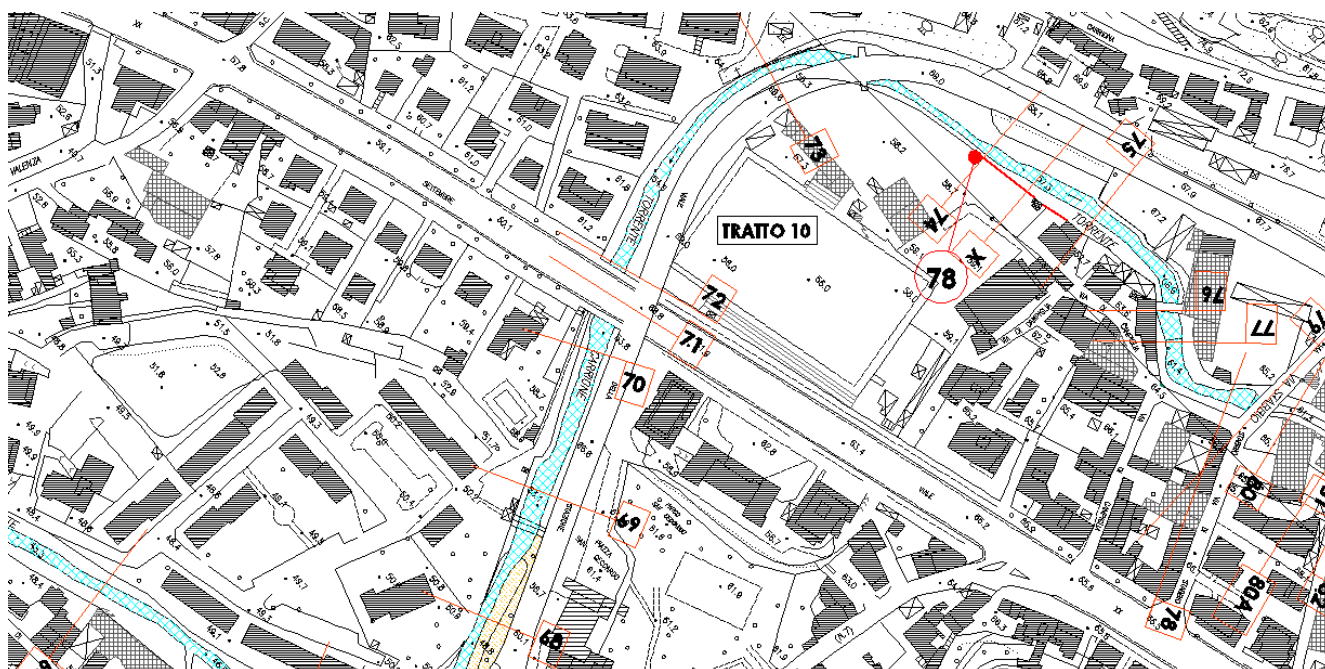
Inquadramento planimetrico – Tratto 10 – Sponda sinistra
